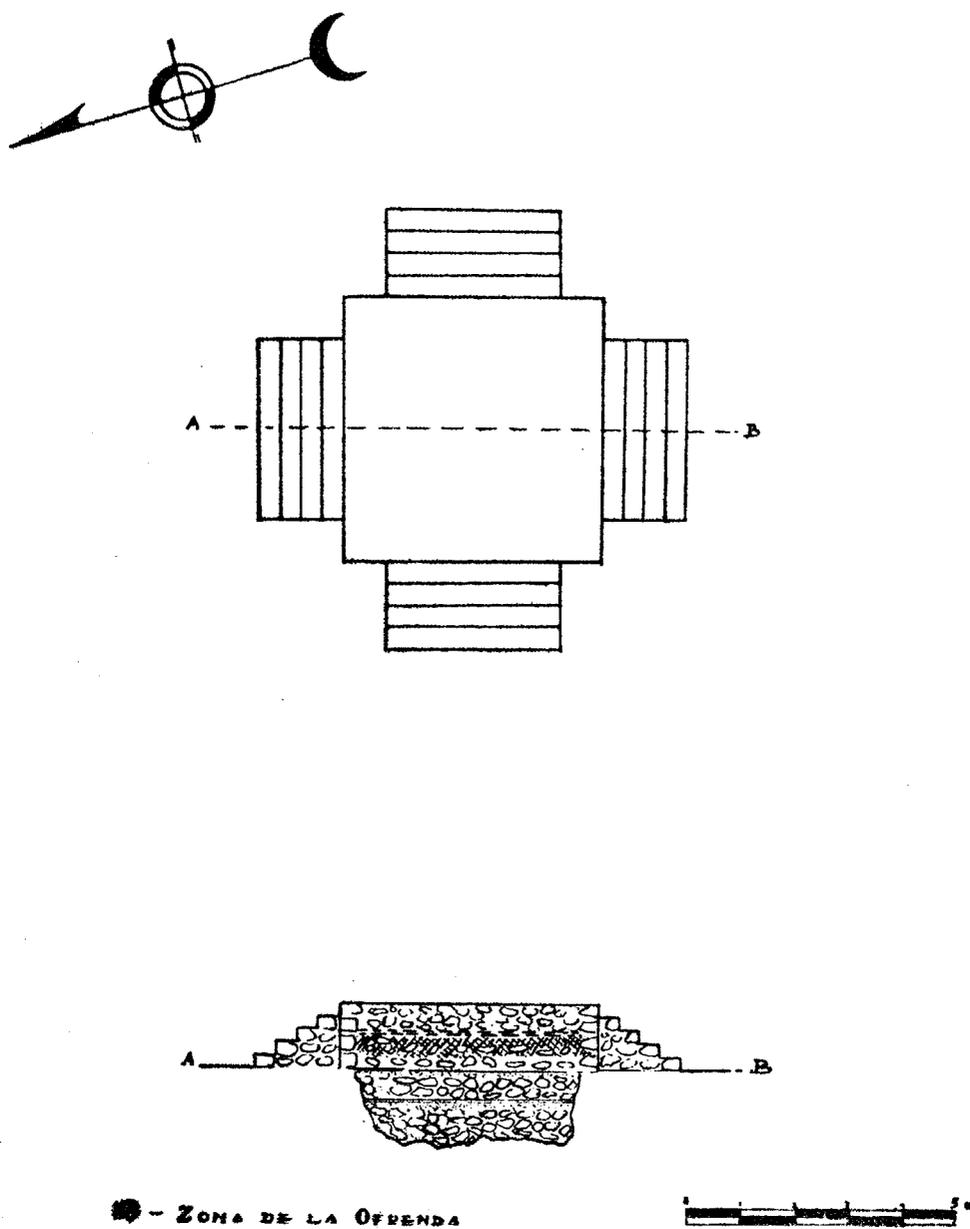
Planta y corte del Adoratorio Central en la gran terraza de El Gobernador.
